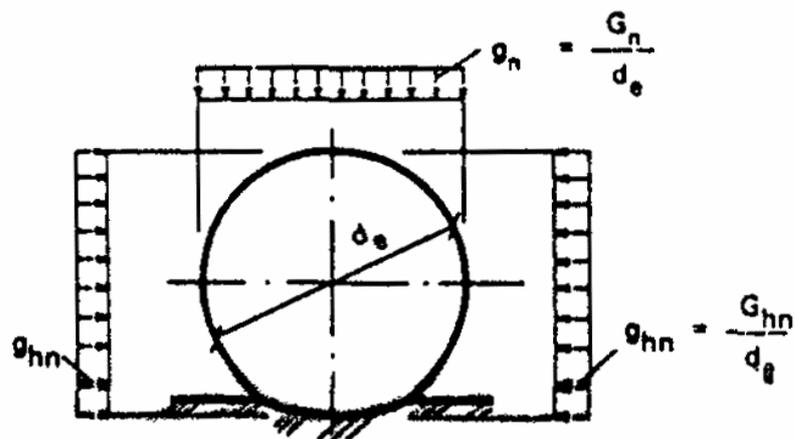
Схема нагрузок на трубопровод от давления грунта и нагрузок, передающихся через грунт
